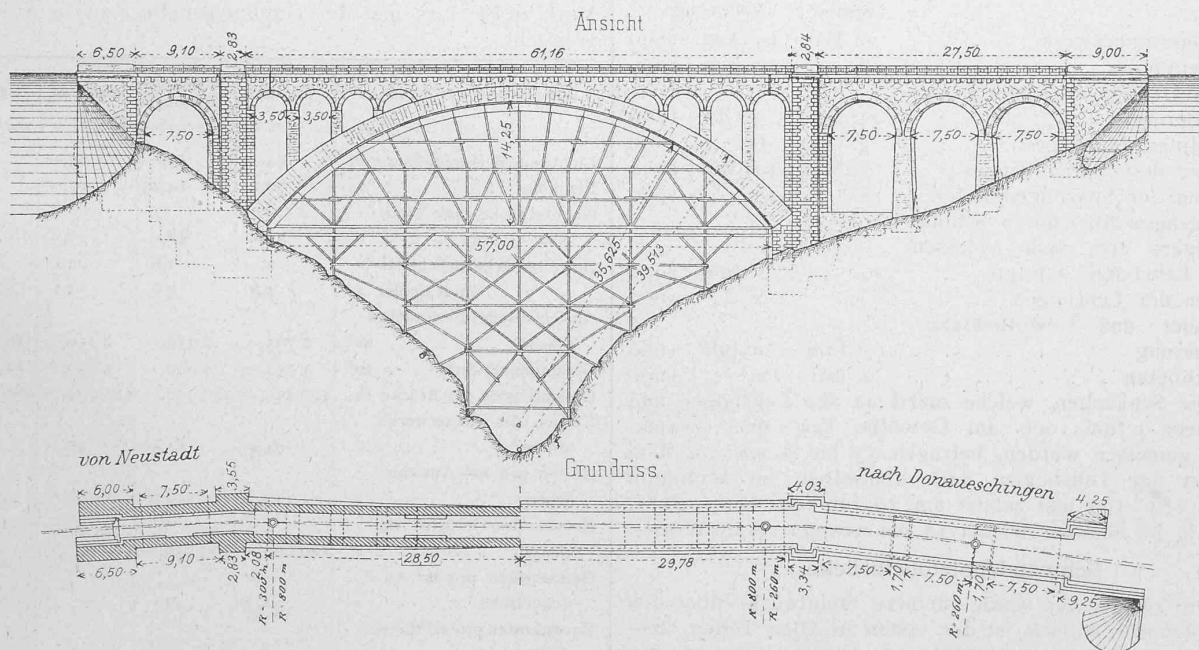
Ansicht und Grundriss. — Masstab 1:750.
